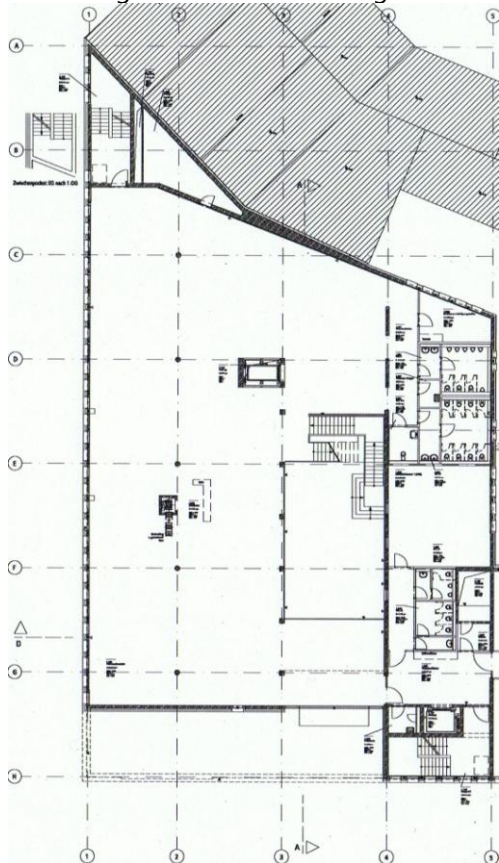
Grundriss 2. Obergeschoss Zentralbibliothek Hamm
